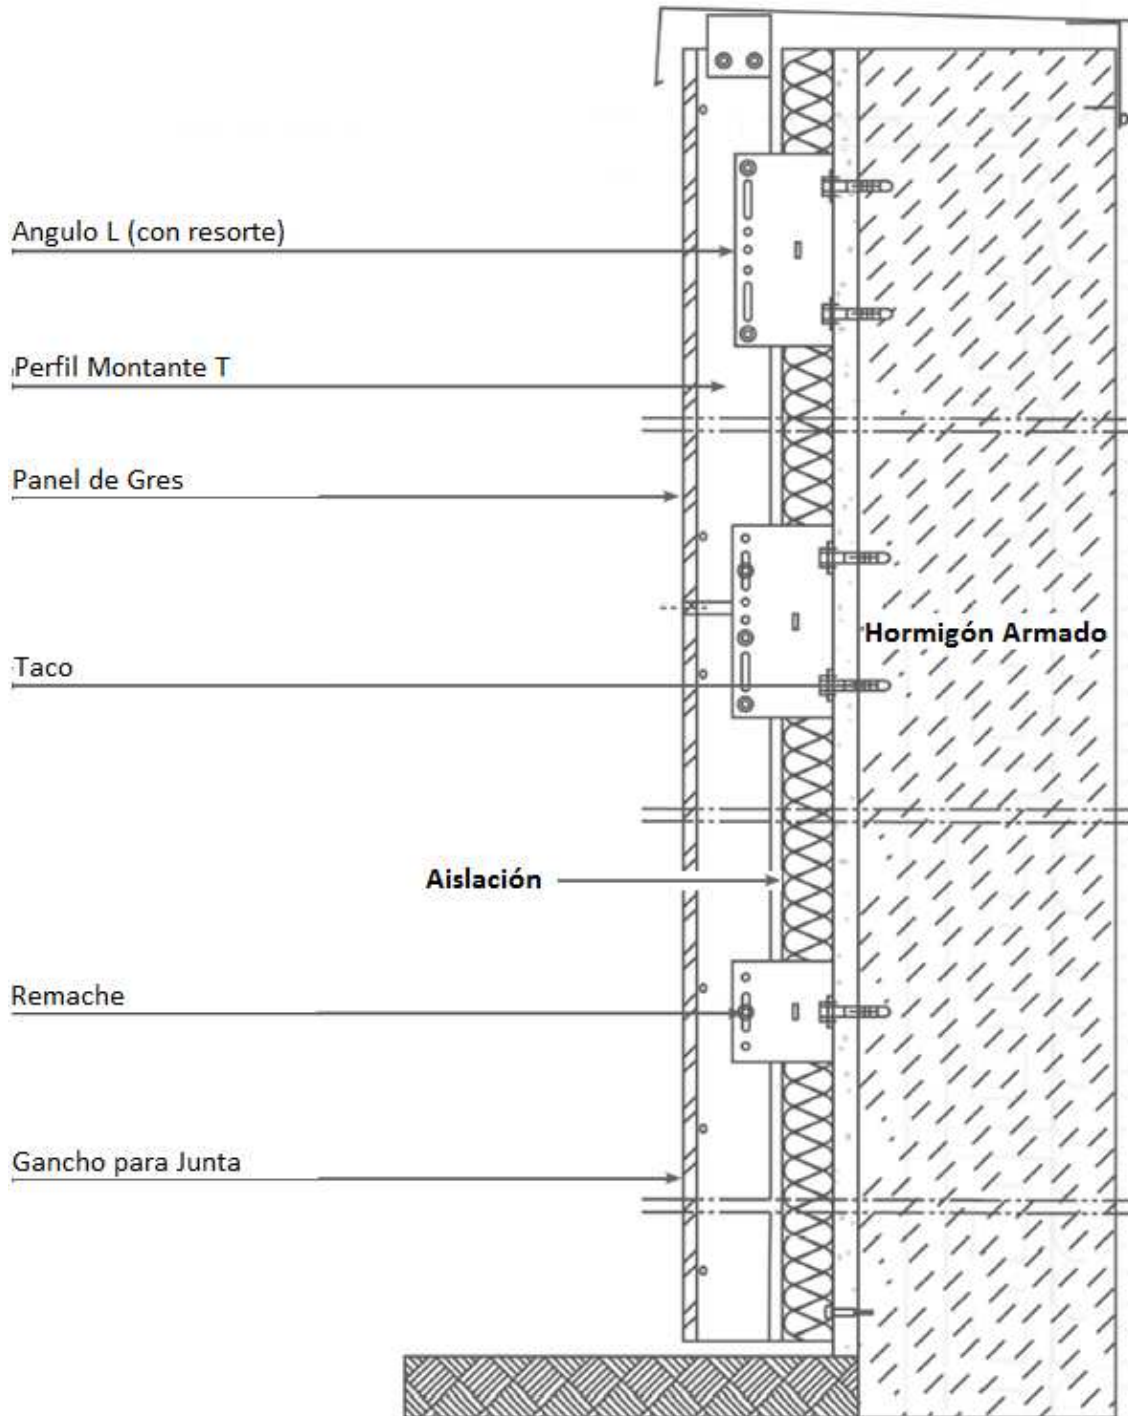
Vista en elevación de detalles de instalación para la fachada ventilada [10]
